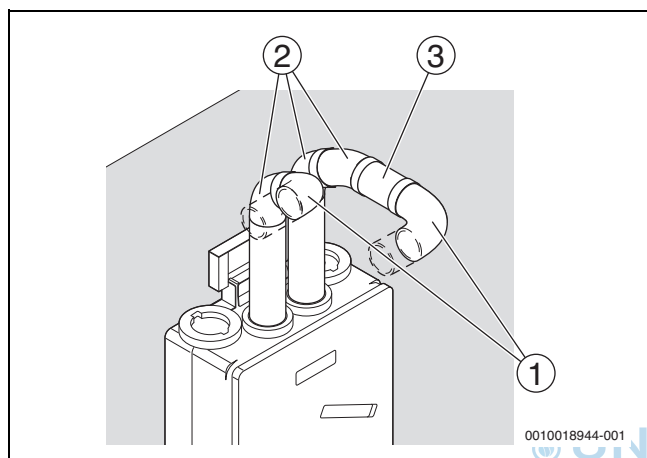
Anschlussdetails zu Bild 36 bis 38: Rohrführung Zu-/Abluftleitung
